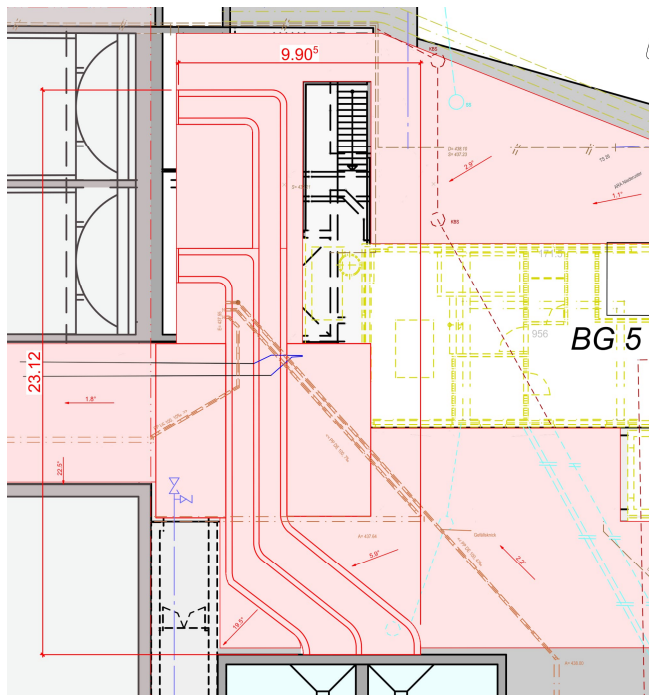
Grundriss neuer Zulaufkanal Vorklärung
